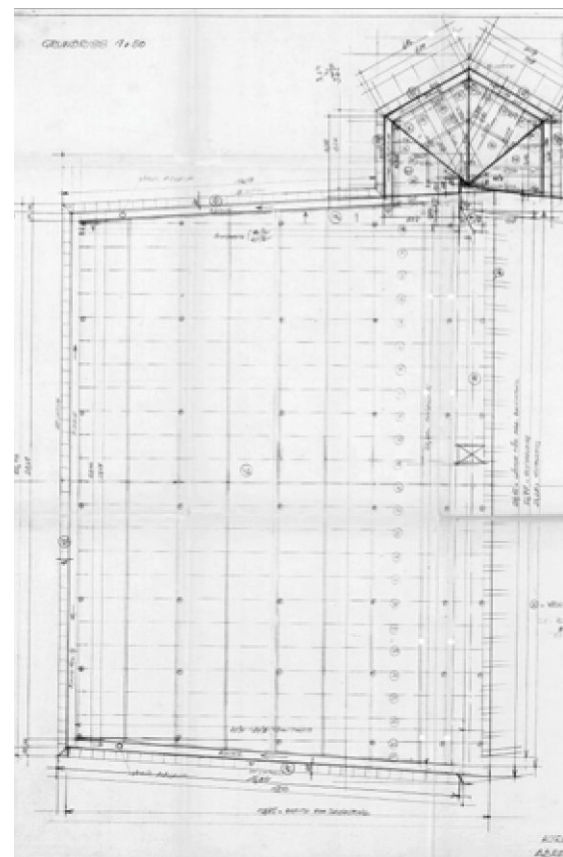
Detailplan-Schrägfensterkonstruktion, 1964
